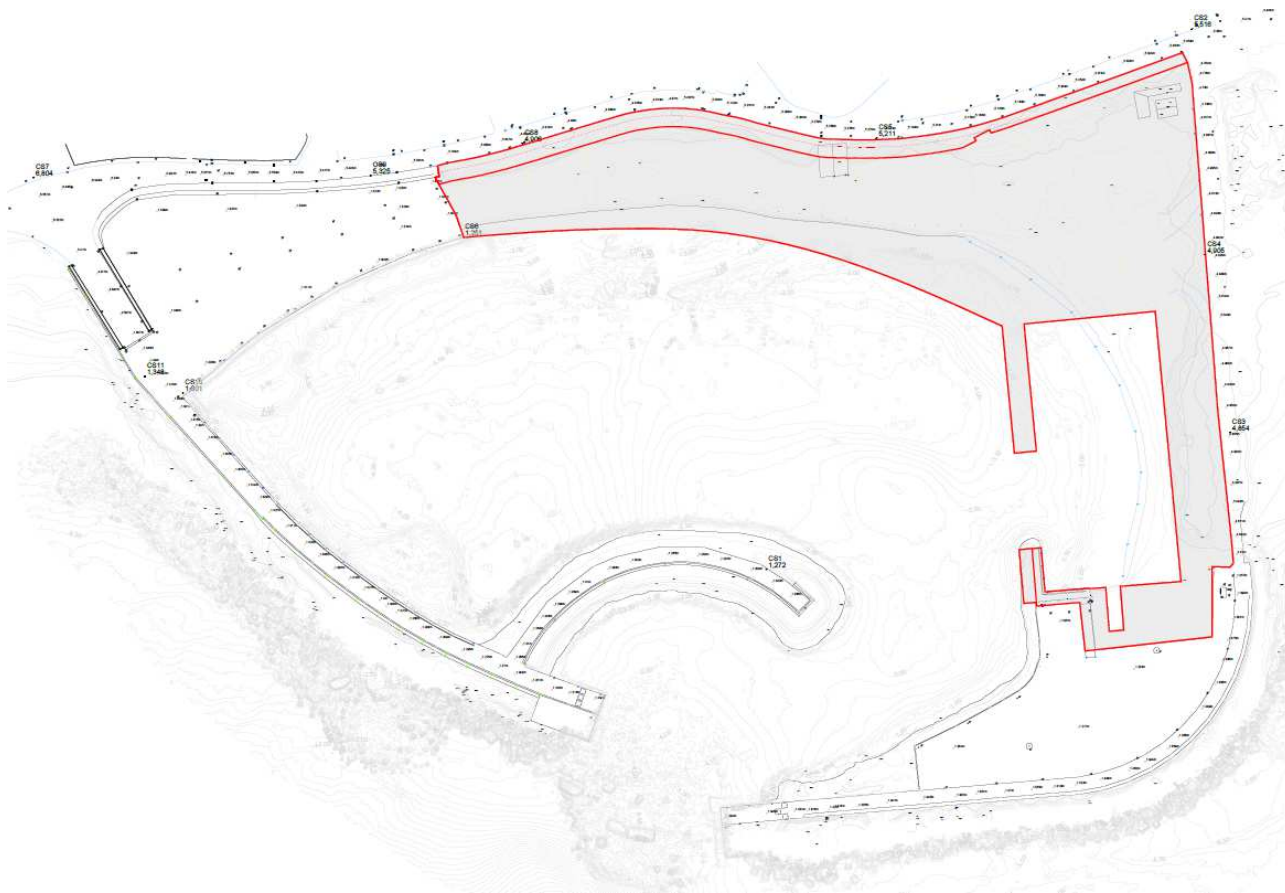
Planimetria generale delle aree d’intervento sovrapposto allo stato di fatto
